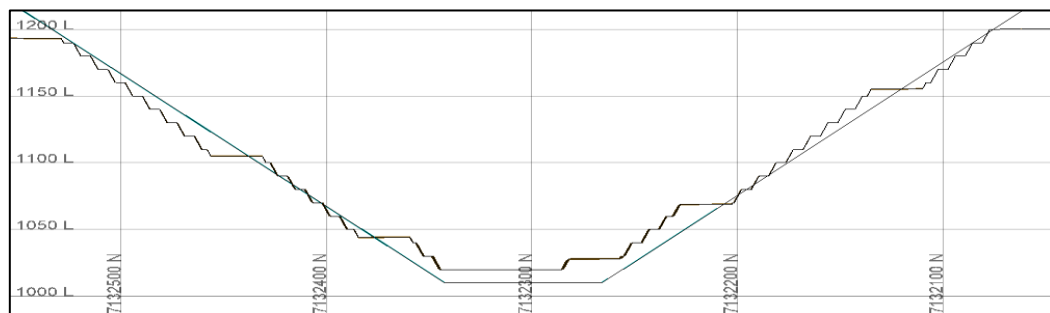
LG2Y Fase 1 - Vista en sección - Corte secundario N-S 394050
